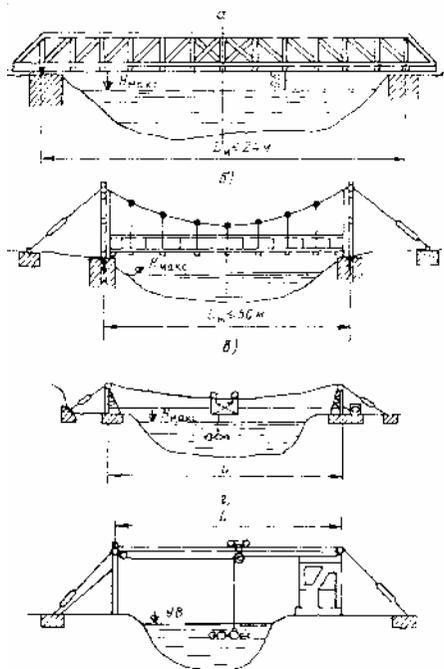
Оборудование гидрометрических створов в зависимости от ширины реки: а – балочный гидрометрический мостик (ширина реки до 20 м); б – подвесной мостик (ширина реки до 80–100 м); в – люлочная переправа (на реках с быстрым течением, высокими берегами, шириной русла 150–200 м); г – дистанционная гидрометрическая установка (ширина русла 100–200 м).
